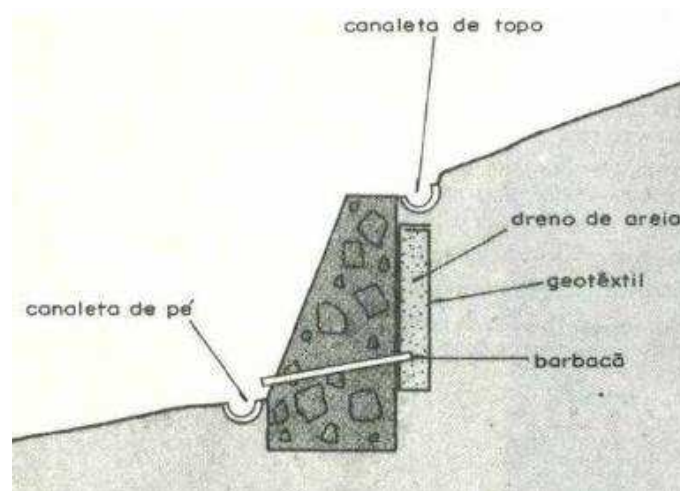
Muro de concreto ciclópico. Fonte: CUNHA (1991).
